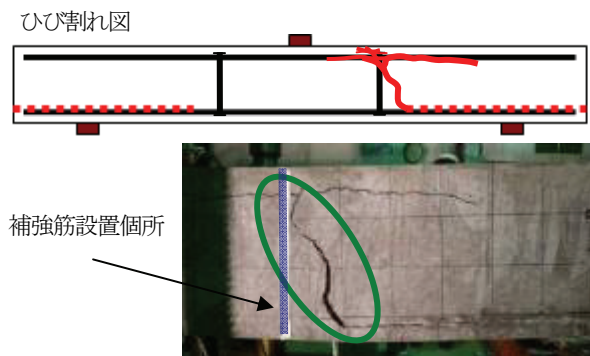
補強試験体1-荷重試験 ひび割れ状況
